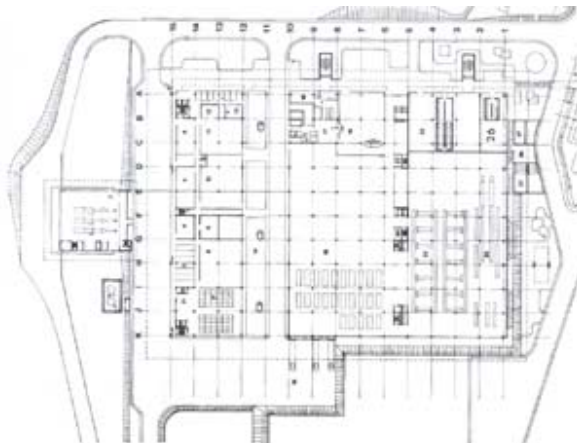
Hering Nordeste: planta baixa subsolo.
